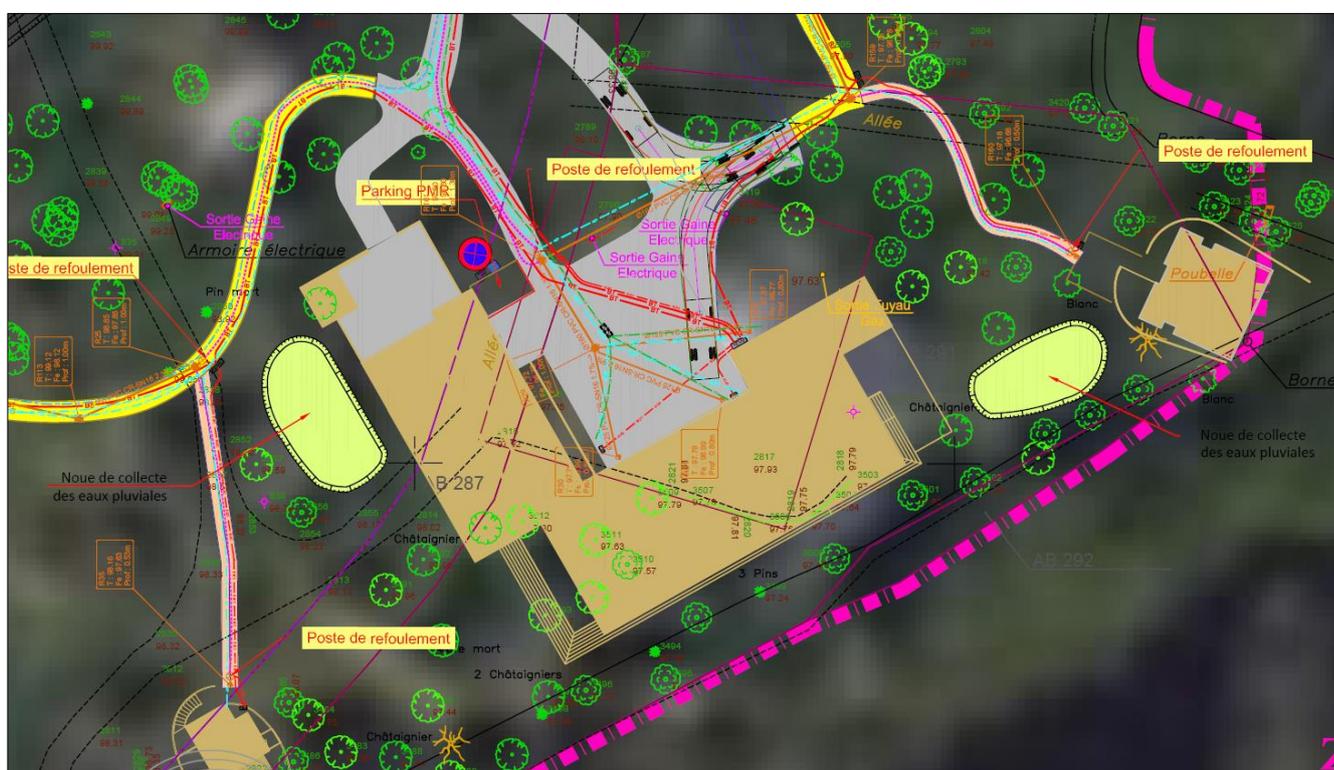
aperçu des ouvrages de collecte des eaux pluviales issues du plan VRD (source : ACP Ingénierie Publique)
